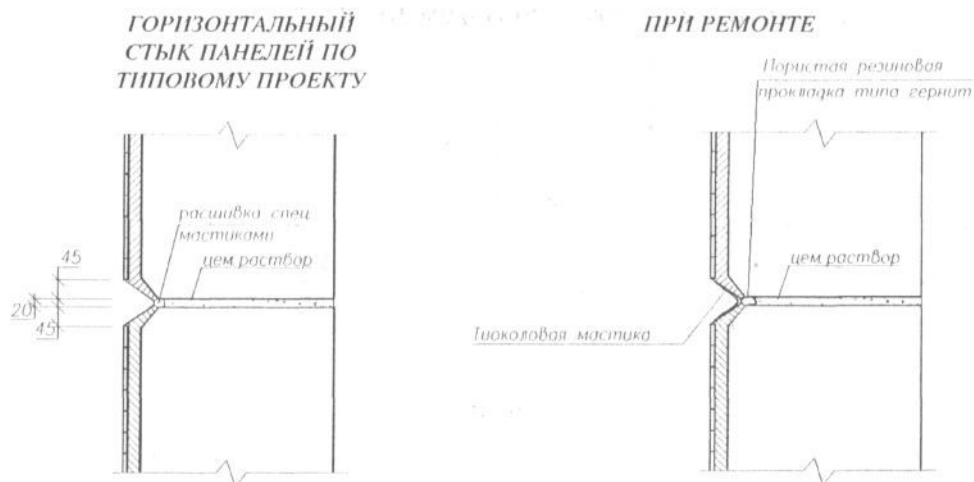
Устранение протечек через горизонтальные стыки наружных стен
